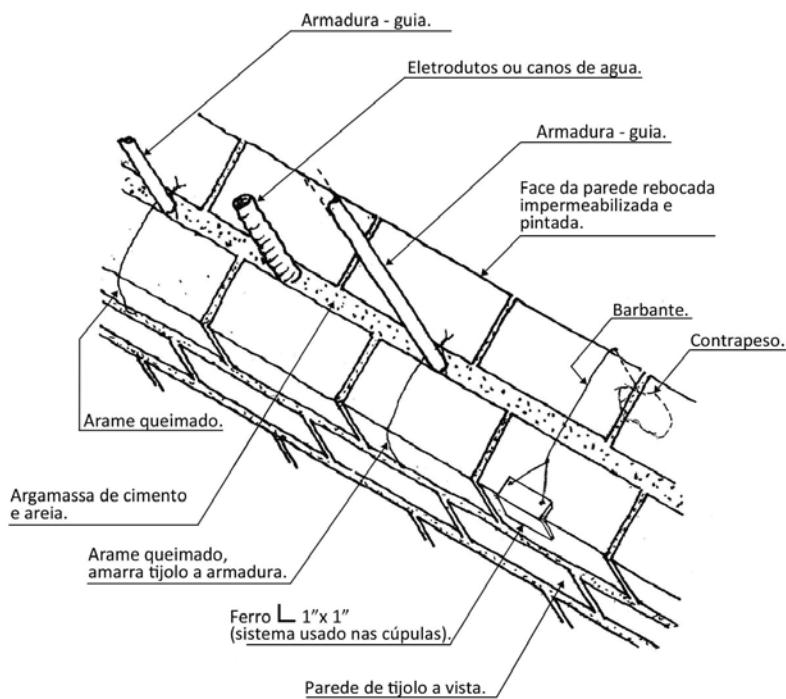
Detalhe da parede dupla de 1/2 tijolo, inclinada, com amarração de tijolo a armadura-guia. (*-5).
